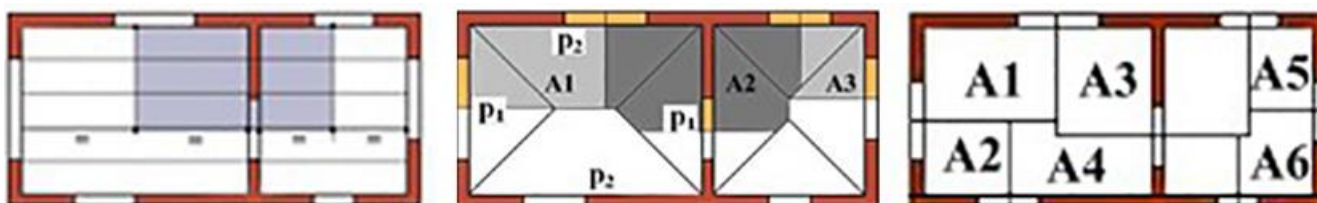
Distribuția încărcărilor de pe planșee pe elementele structurale verticale.
